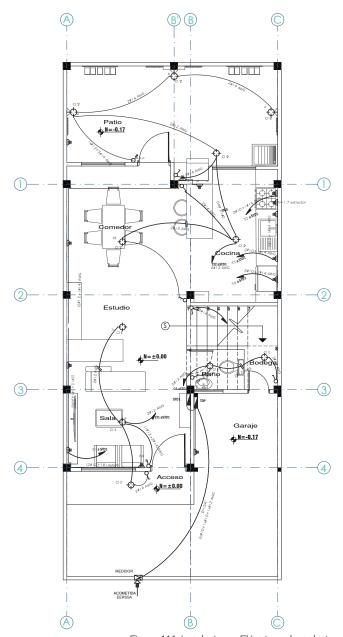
Instalaciones Eléctricas planta baja Nota: Elaborado por el autor
